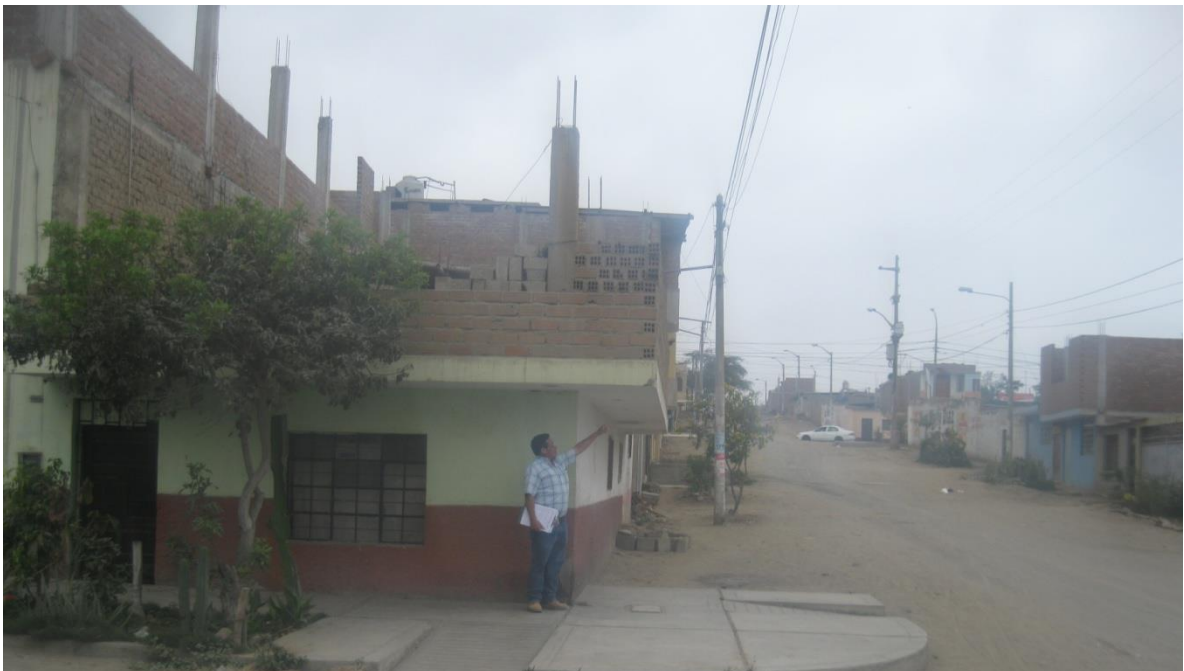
FIERRO EXPUESTO DE COLUMNAS EN ZONA DE TRASLAPE
